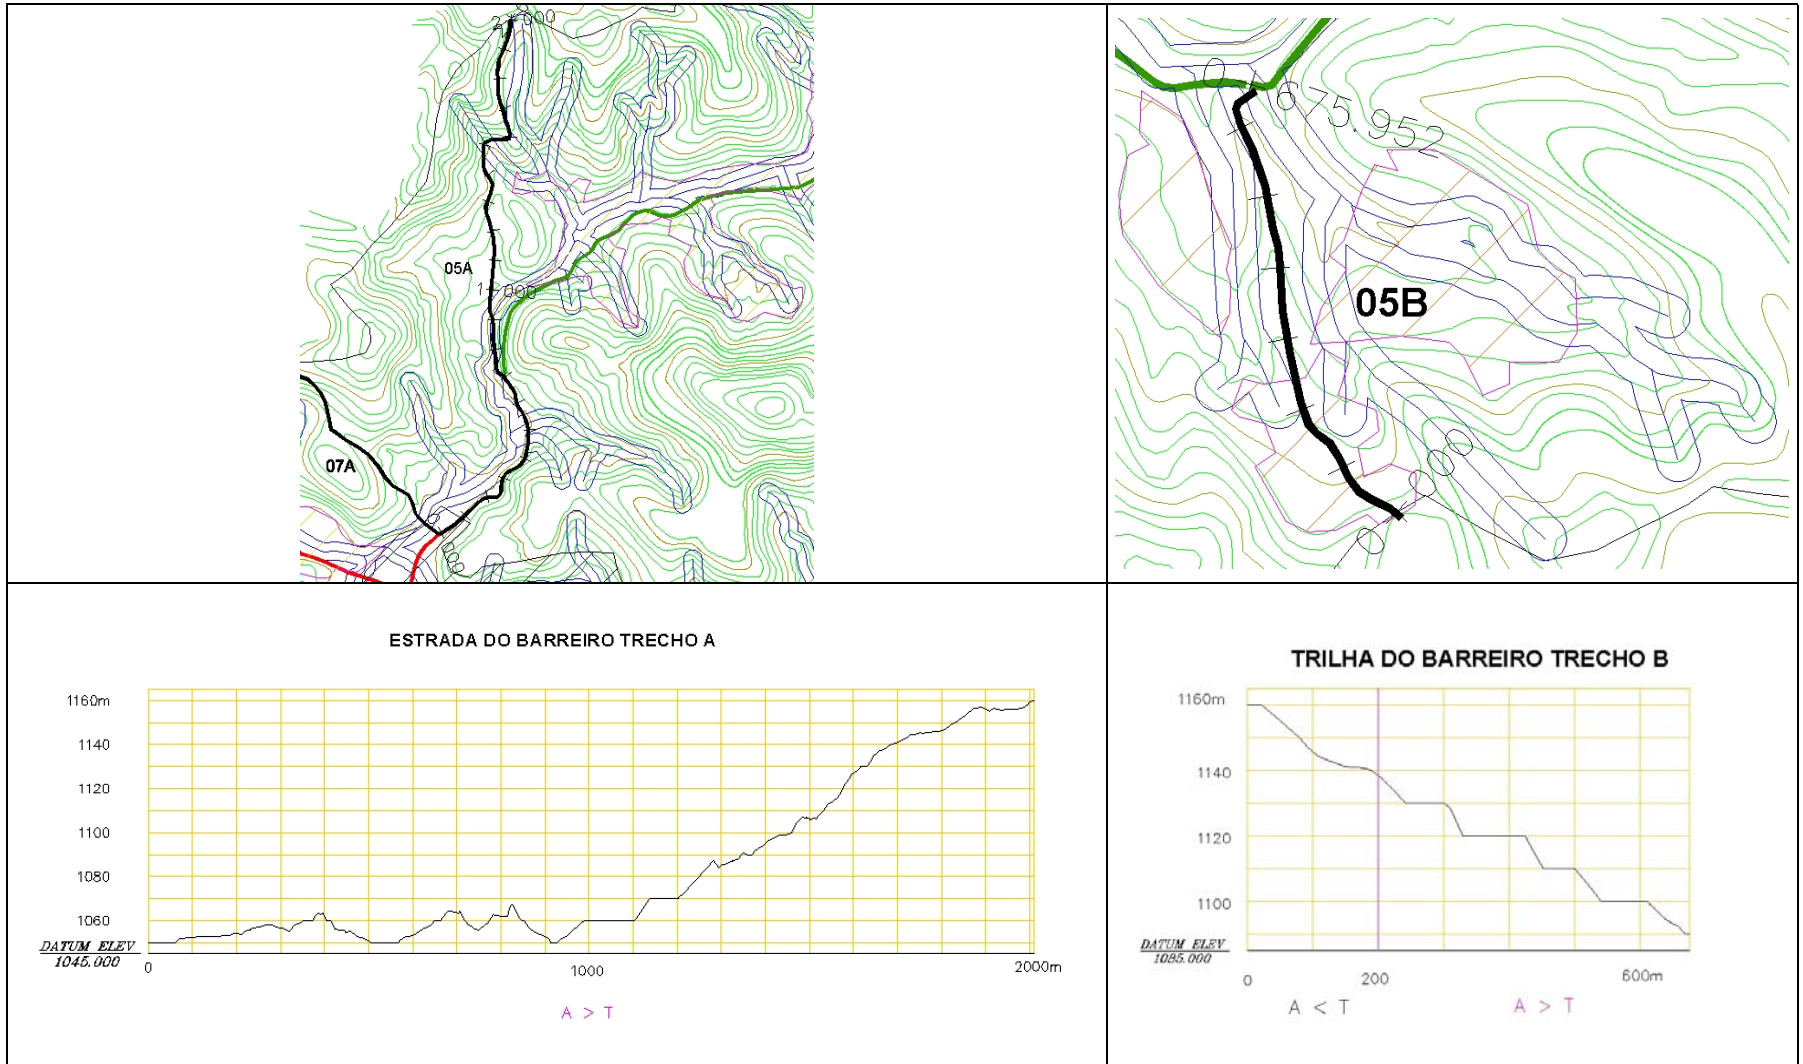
Planta e Perfil Topográfico da Estrada do Barreiro Trechos A e B – 05A (MB5) e 05B (MB4)
